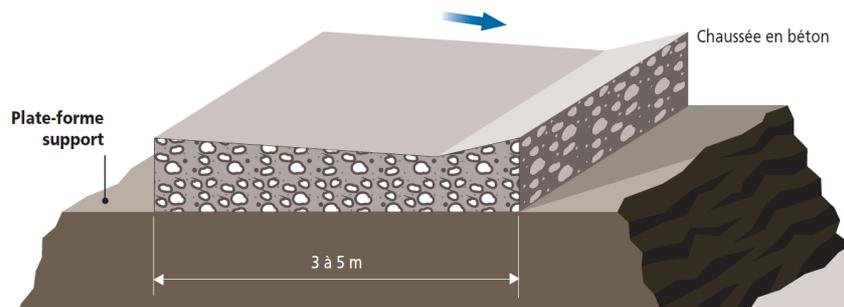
Chaussée à écoulement latéral, profil à contre pente (source : Cimbéton)
